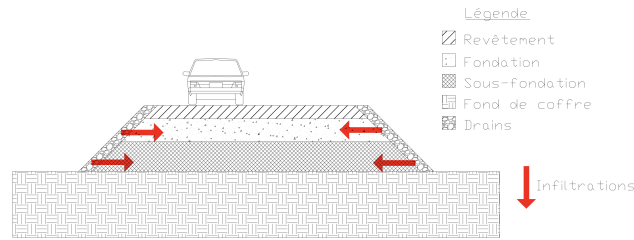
Infiltrations depuis les drains latéraux (revêtement imperméable)
